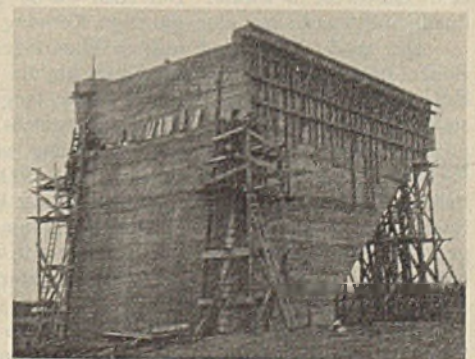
Rechtseitiges Widerlager vor Fertigstellung.
